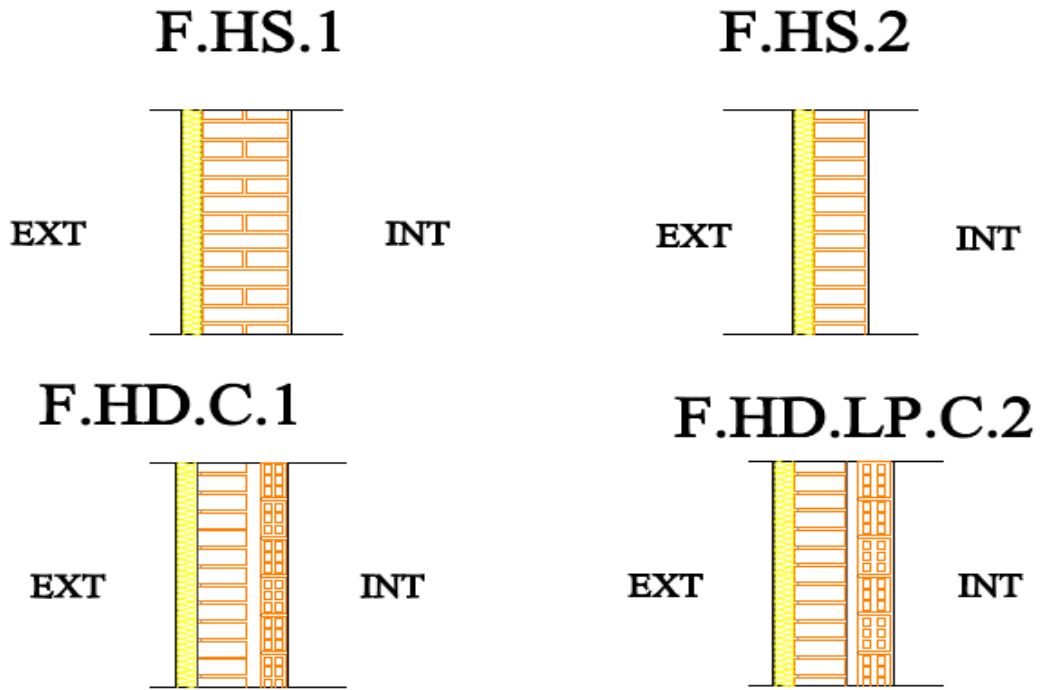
Reforma exterior de fachada con panel tipo sandwich
